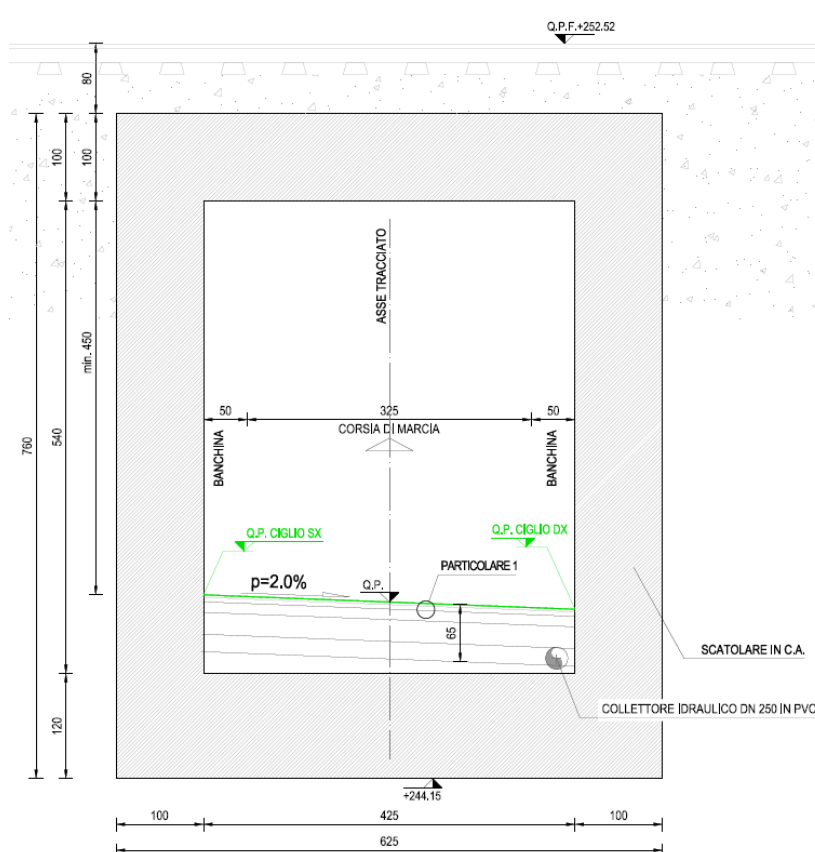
Sezione manufatto di progetto – Via San Francesco
